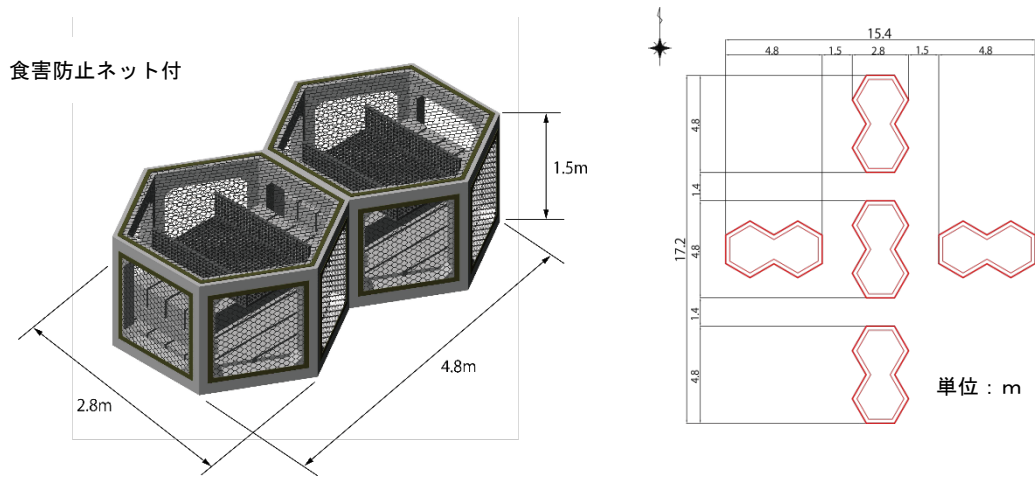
沖ノ鳥島の間育成施設の姿図と配置図
